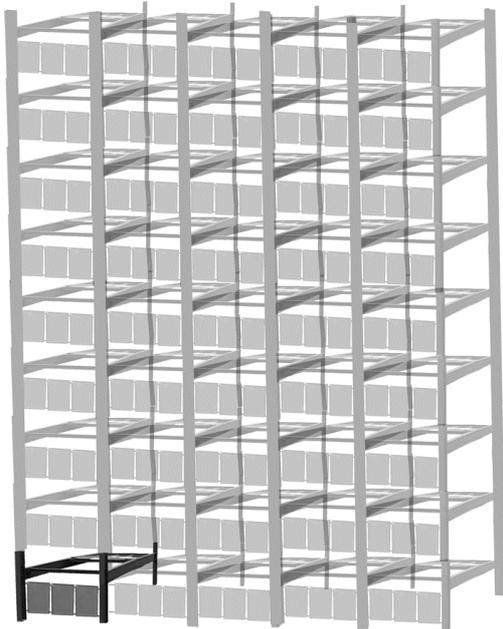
Gesamtansicht des temporären Parkhauses und Demonstratorausschnitt (Schema)
